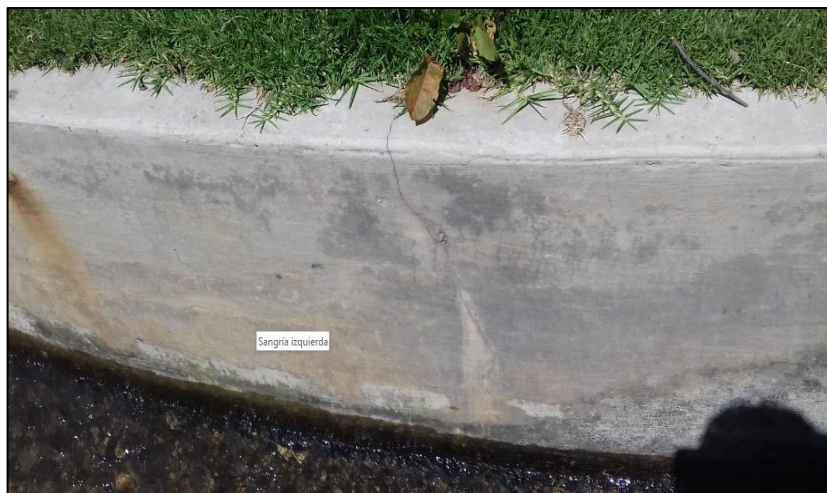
Fisuras en las paredes de la caja del canal.
